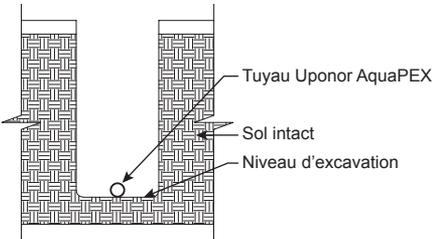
Condition du sol favorable — Si l'excavation de la tranchée se fait sans problème, installer la tuyauterie directement sur le fond préparé. Le fond doit être plat, sans trous, bosses ou cailloux.
